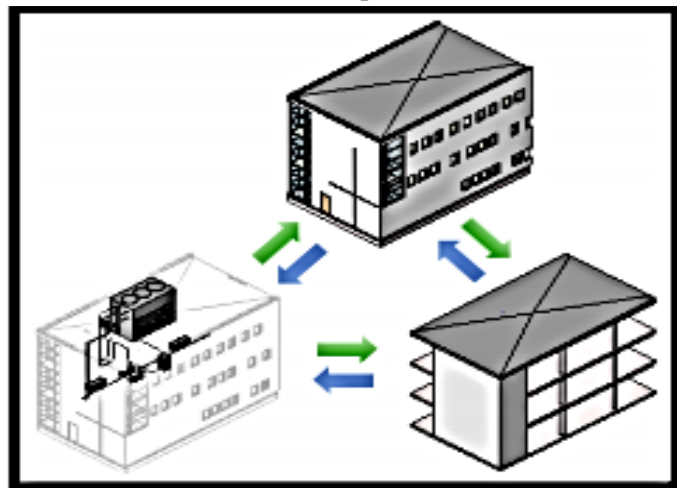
Ejemplo de estructuración: arquitectura, predimensionamiento e instalaciones.
